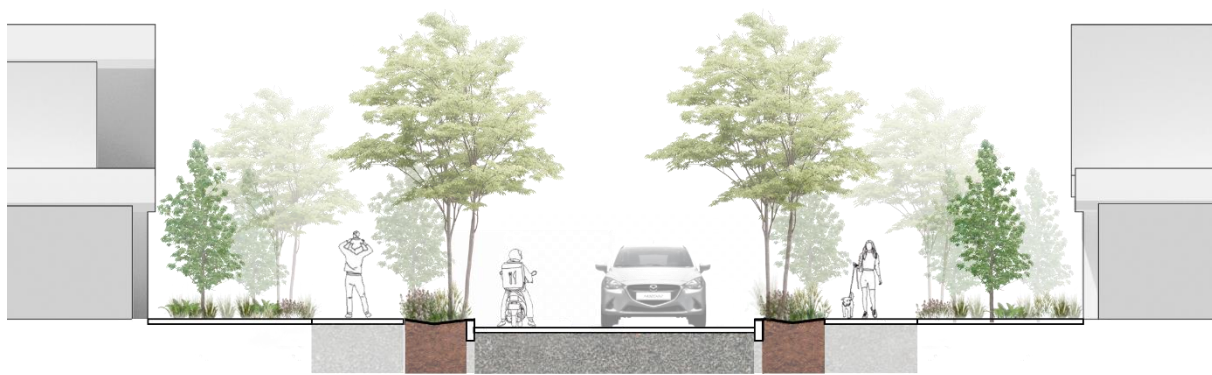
Calle Local Tipo 4 - Axonometría y Sección de Propuesta
